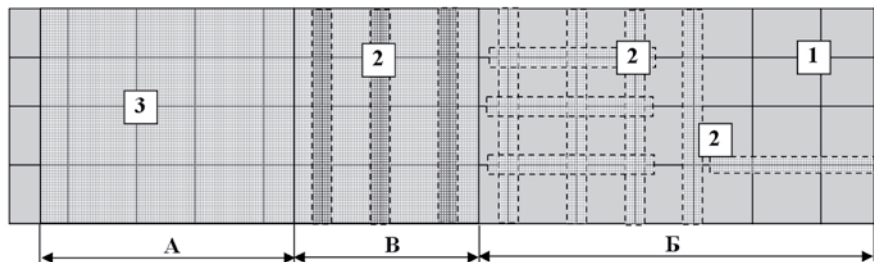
Схемы укладки геосетки: А – сплошная; Б – участковая; В – комбинированная; 1 – «старое» покрытие со швами (трещинами); 2 – полосы геосетки; 3 – полотно геосетки
